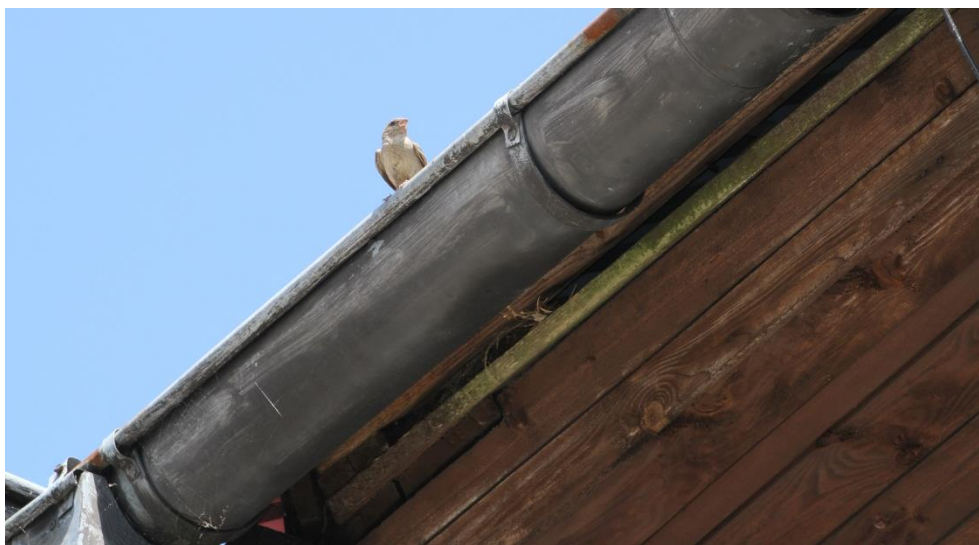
Materiał gniazdowy w elementach konstrukcji dachu (szczelina wentylacyjna) (fot. L.K.).
